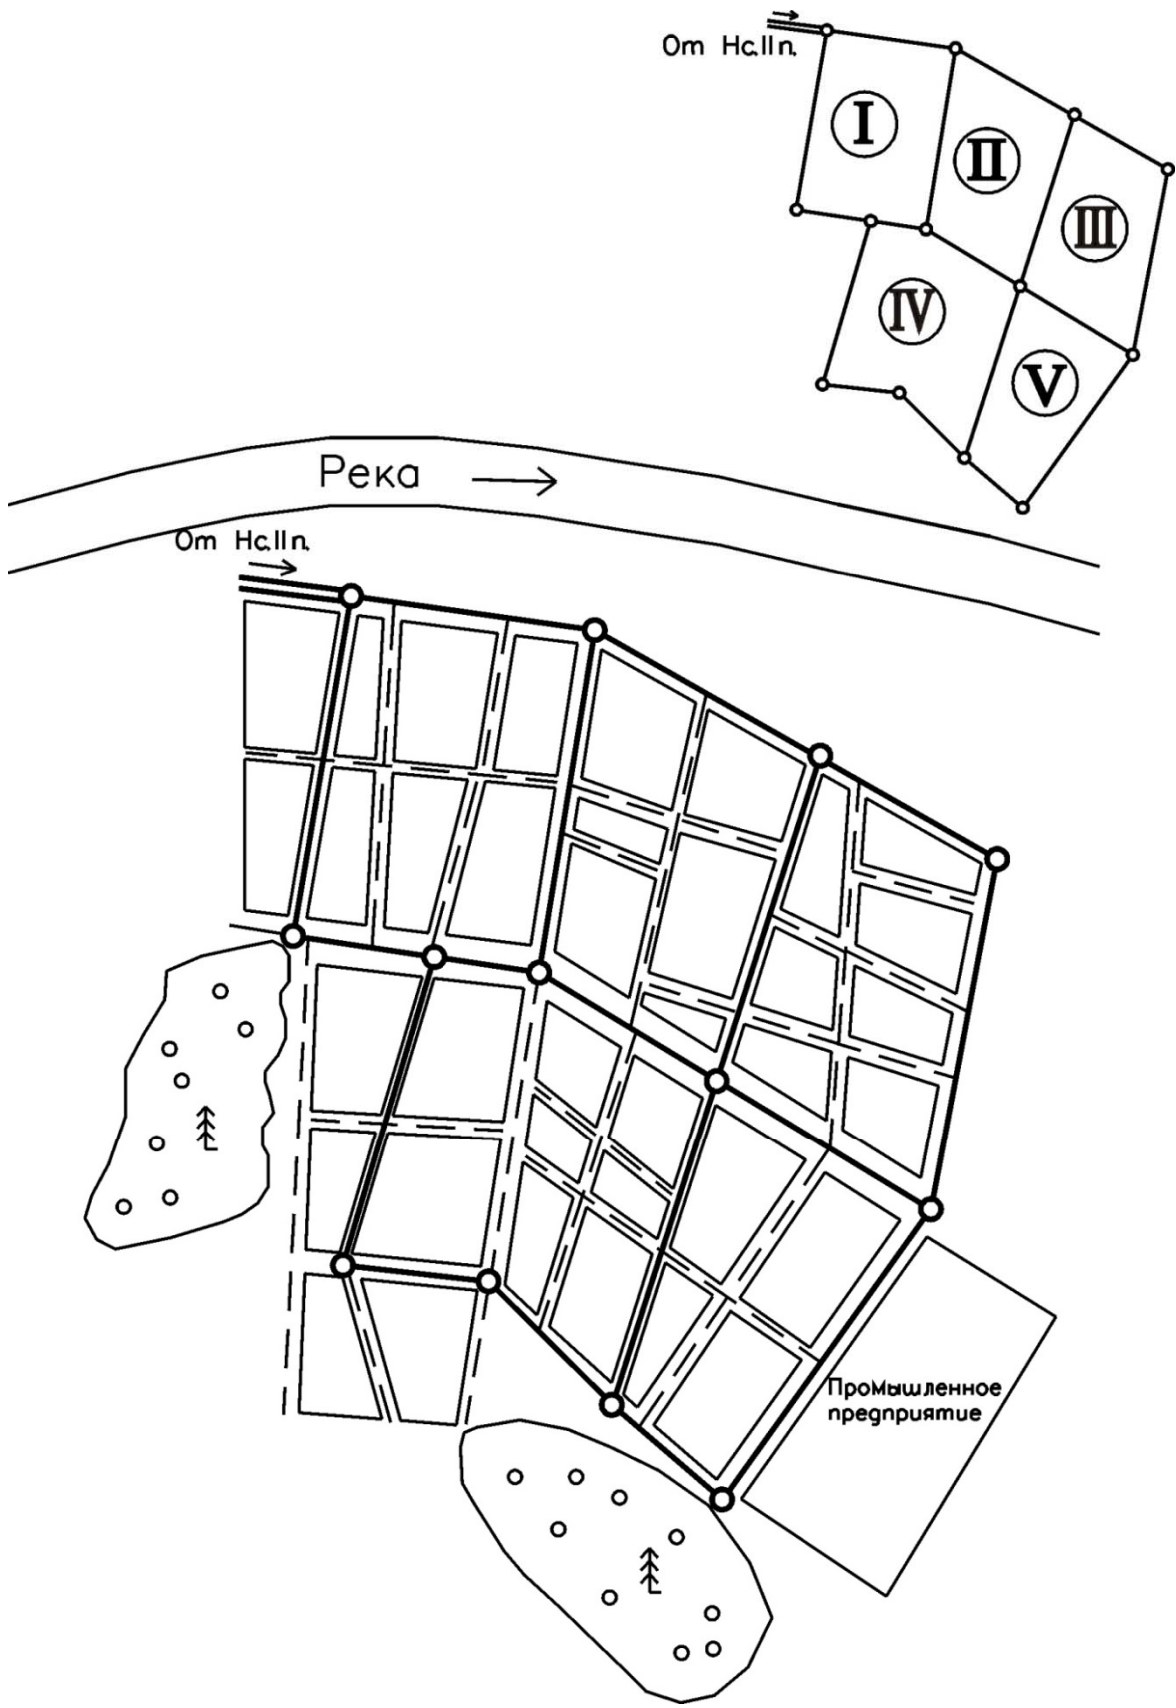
г. Генплан №3 со схемой трассировки водопроводной сети (вариант 3)
